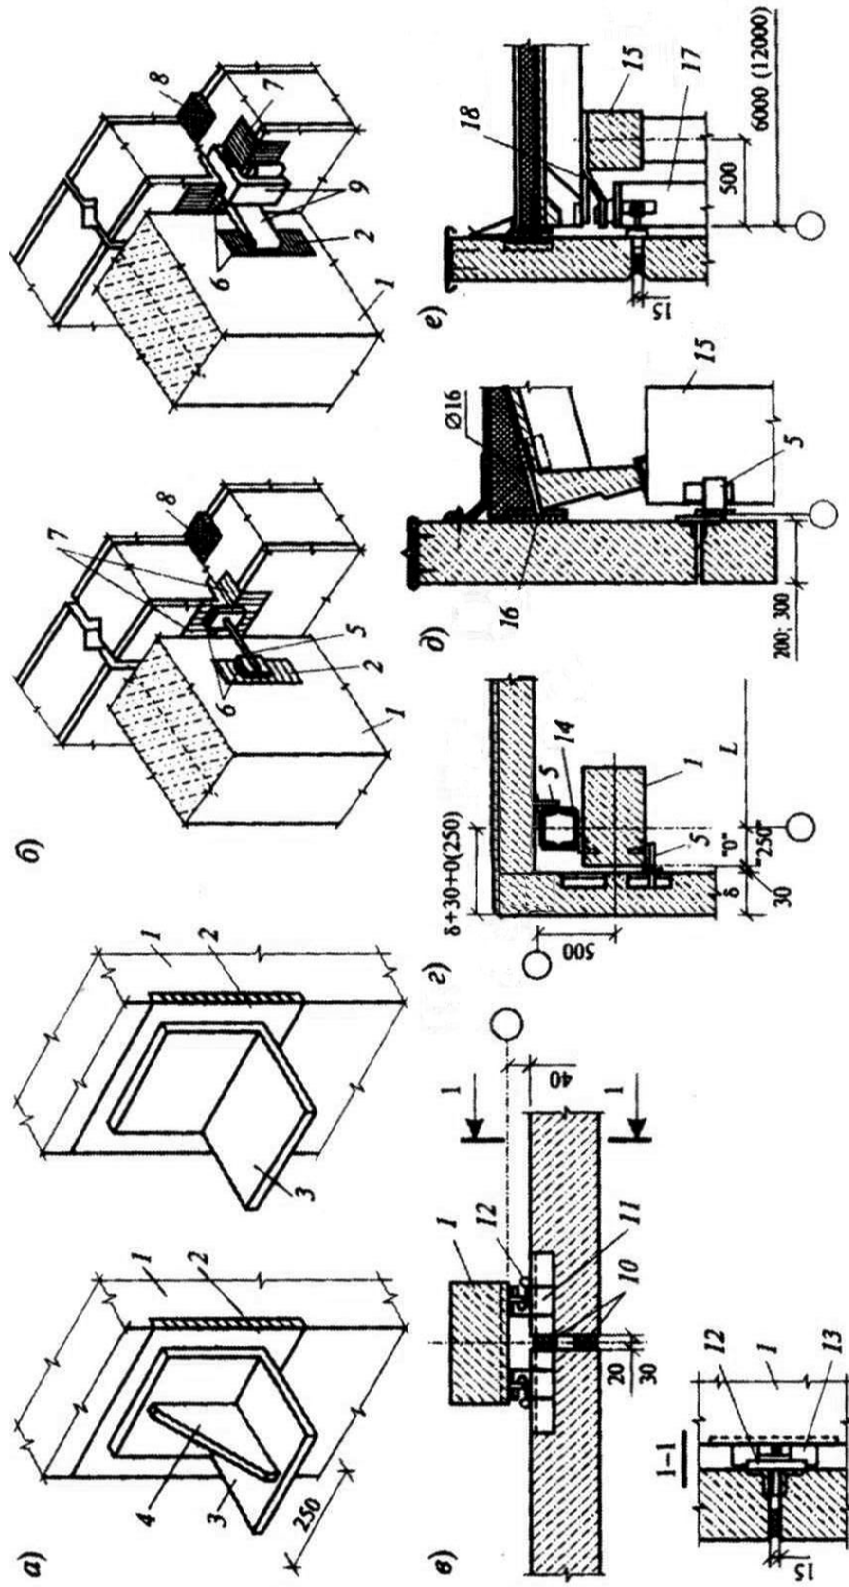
Детали конструкций стен из бетонных и железобетонных панелей горизонтальной разрезки:
